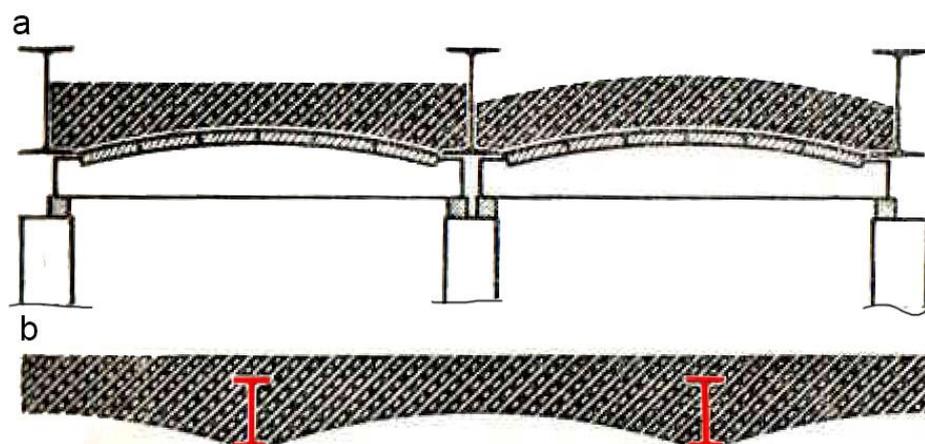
Огнестойкое перекрытие с монолитными бетонными сводами:
